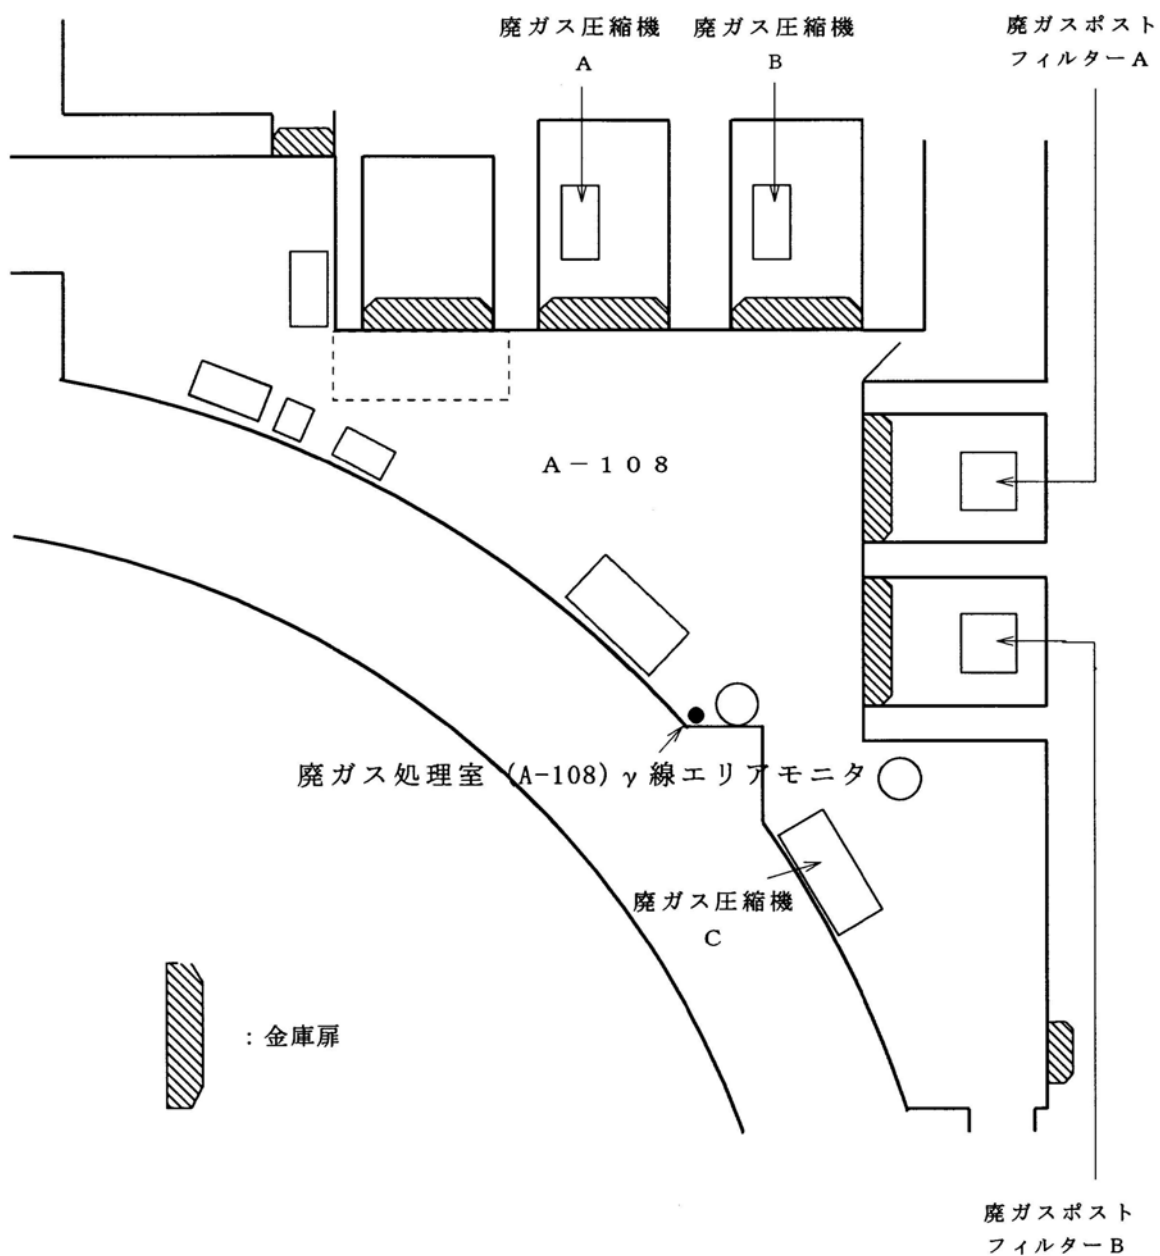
原子炉付属建家 A-108 γ線エリアモニタ配置図
